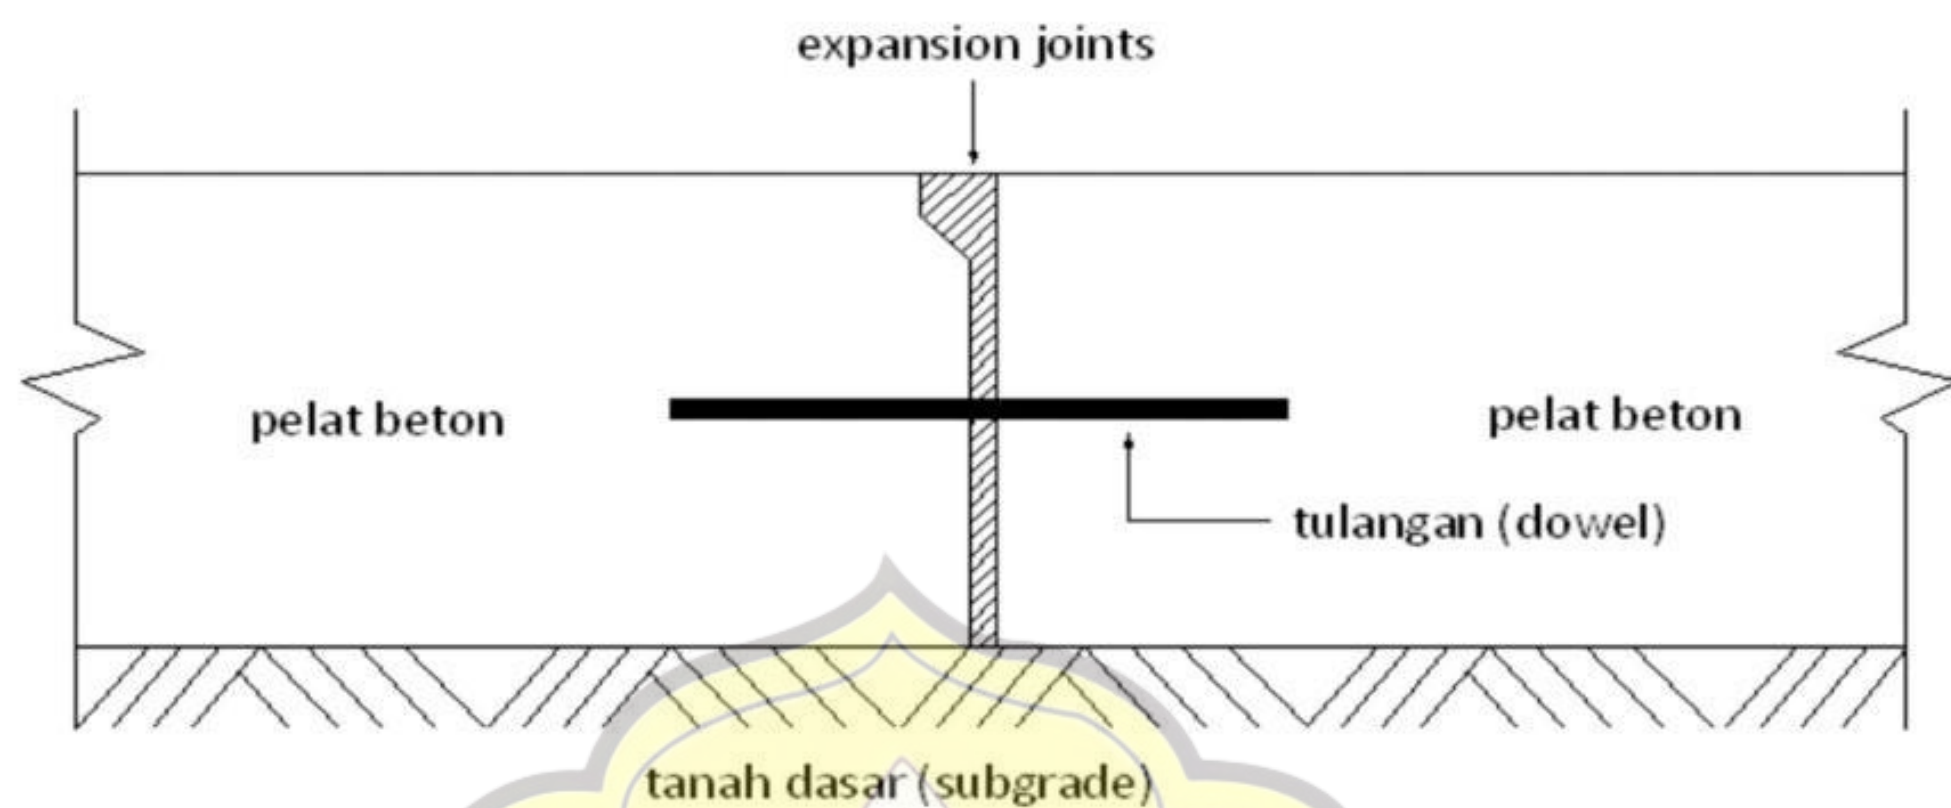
Tipikal struktur perkerasan beton semen
